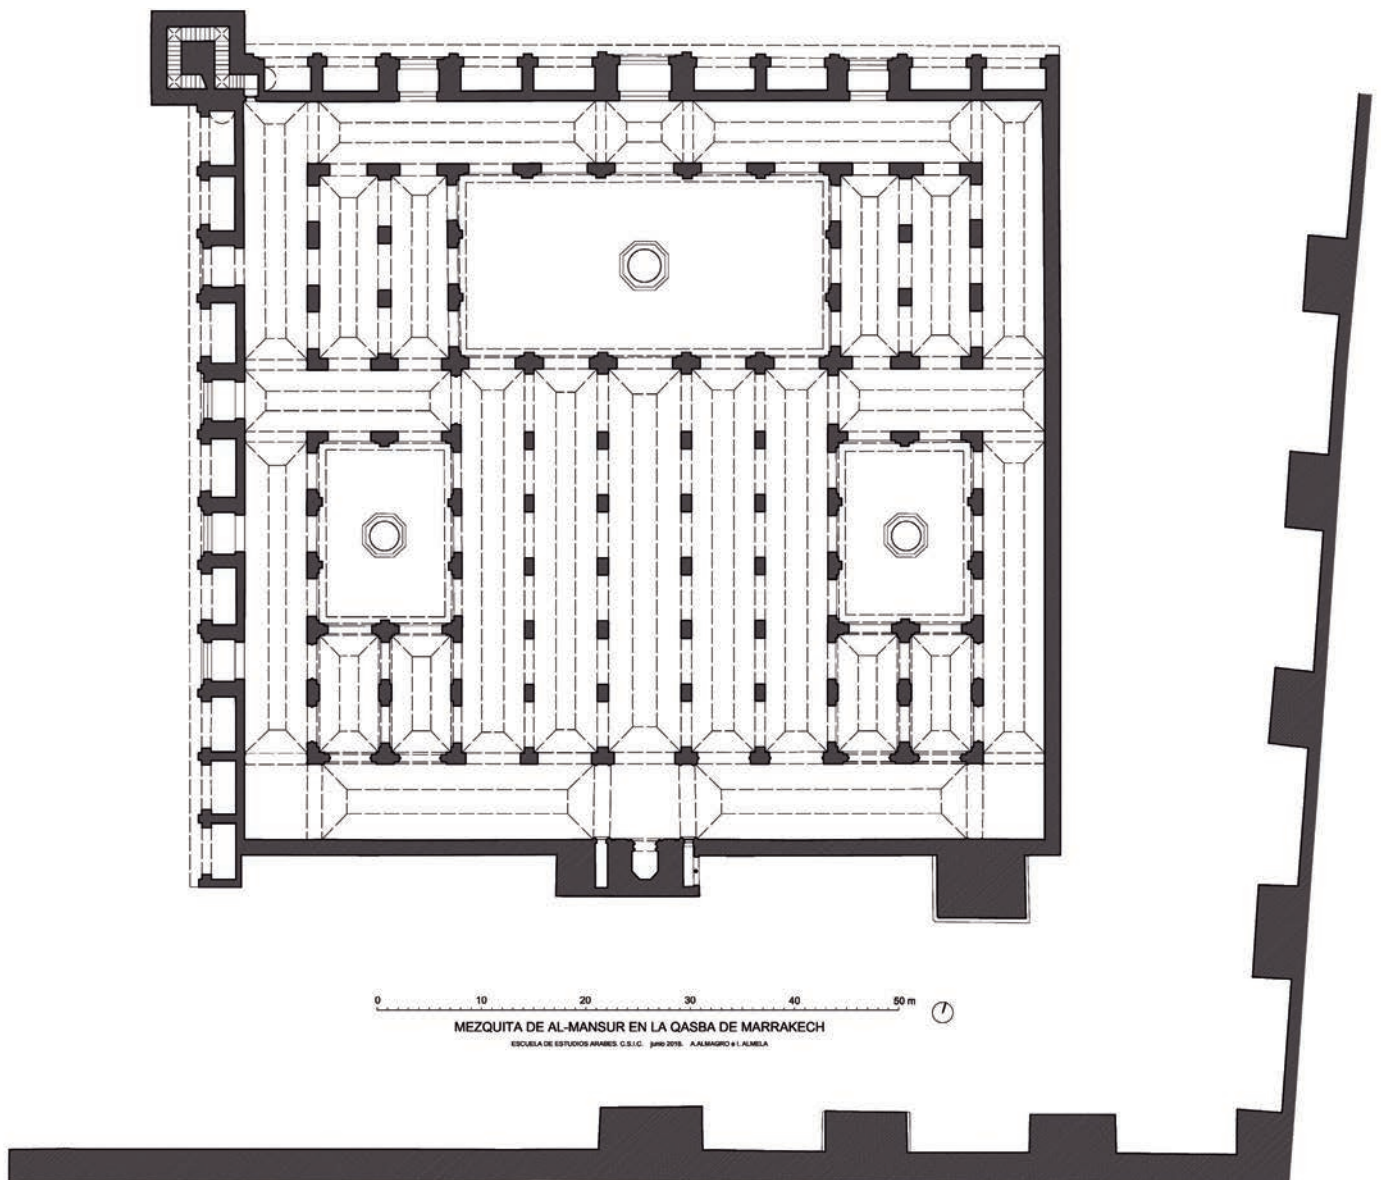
Mezquita de la Qasba. Planta hipotética en su fase fundacional. Plano del autor.
